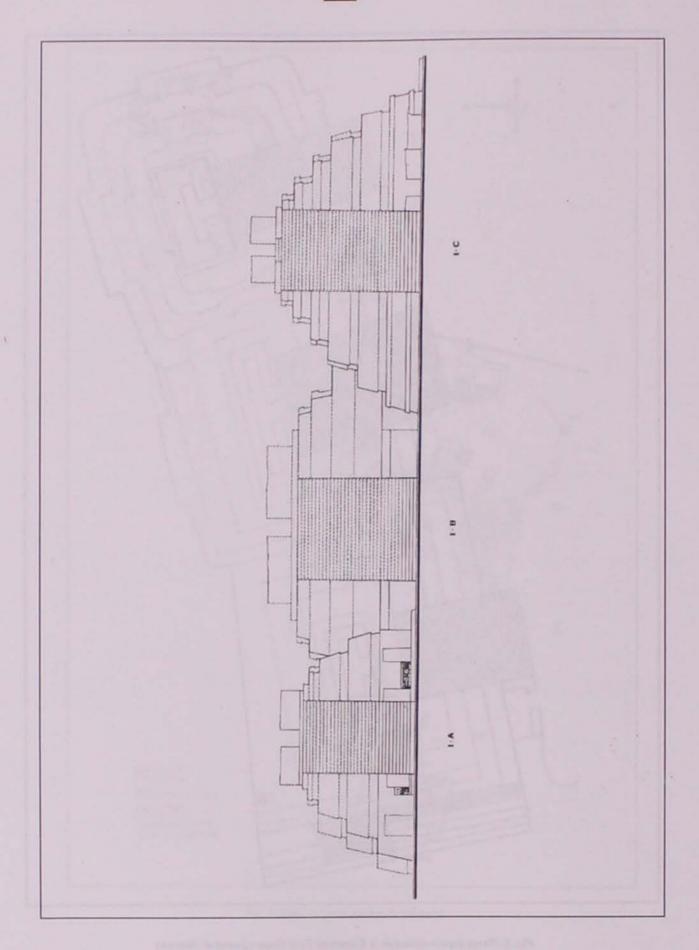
Alzado sur de la Estructura no. 1 del Grupo Central de Balamkù
